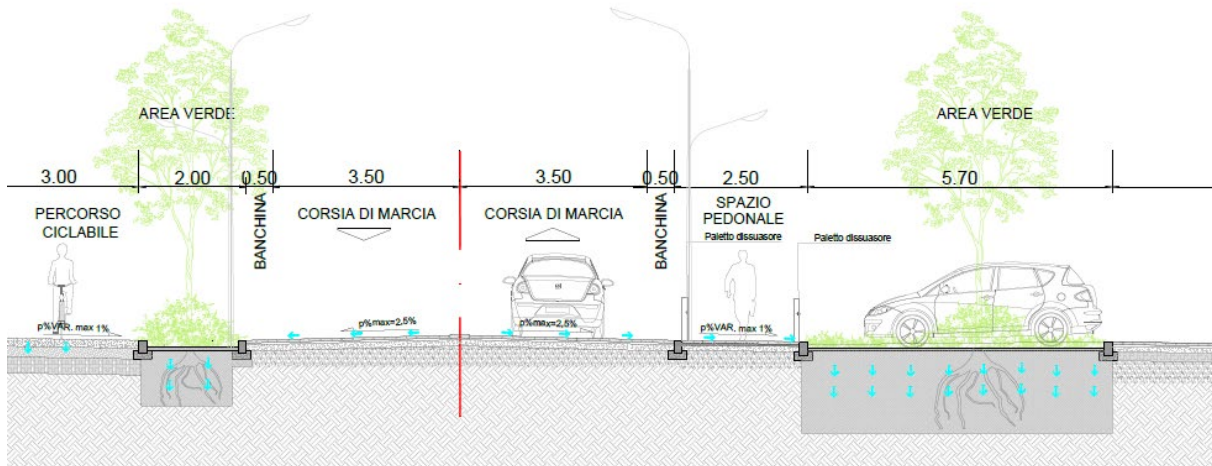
Dettaglio tipologico – smaltimento acque coadiuvato da filtrazione naturale nel progetto della sezione stradale
